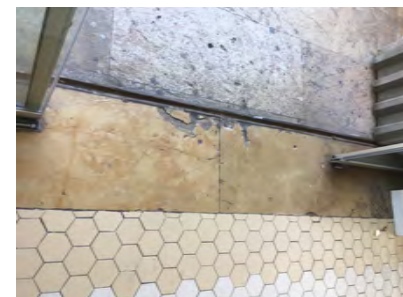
Detalle de los distintos pavimentos existentes en el ámbito de la puerta
